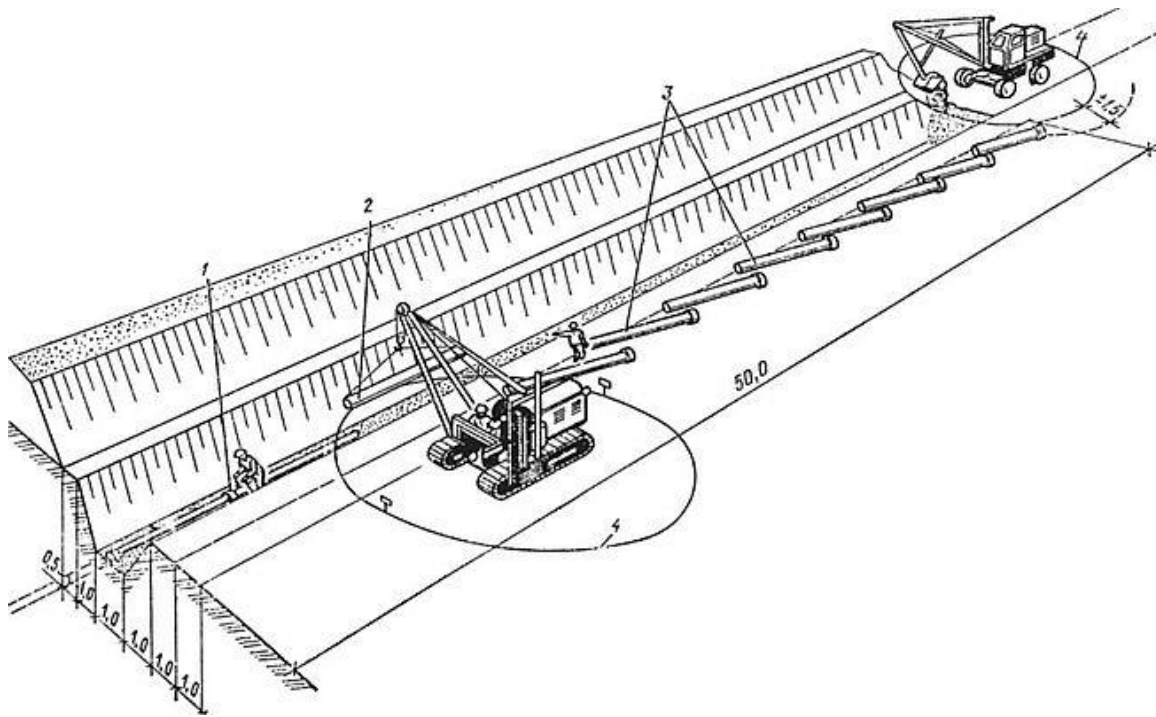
Монтаж труб краном-трубоукладачем:
